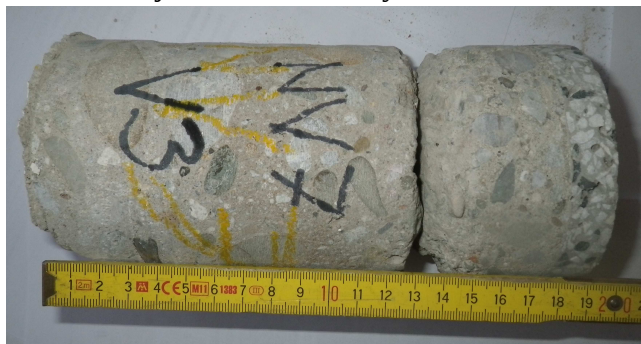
jádro V 4 ze sonda NV 8 – beton desky se při vrtání rozpadnul, zatímco betonová mazanina podlahy je výrazně kvalitější
